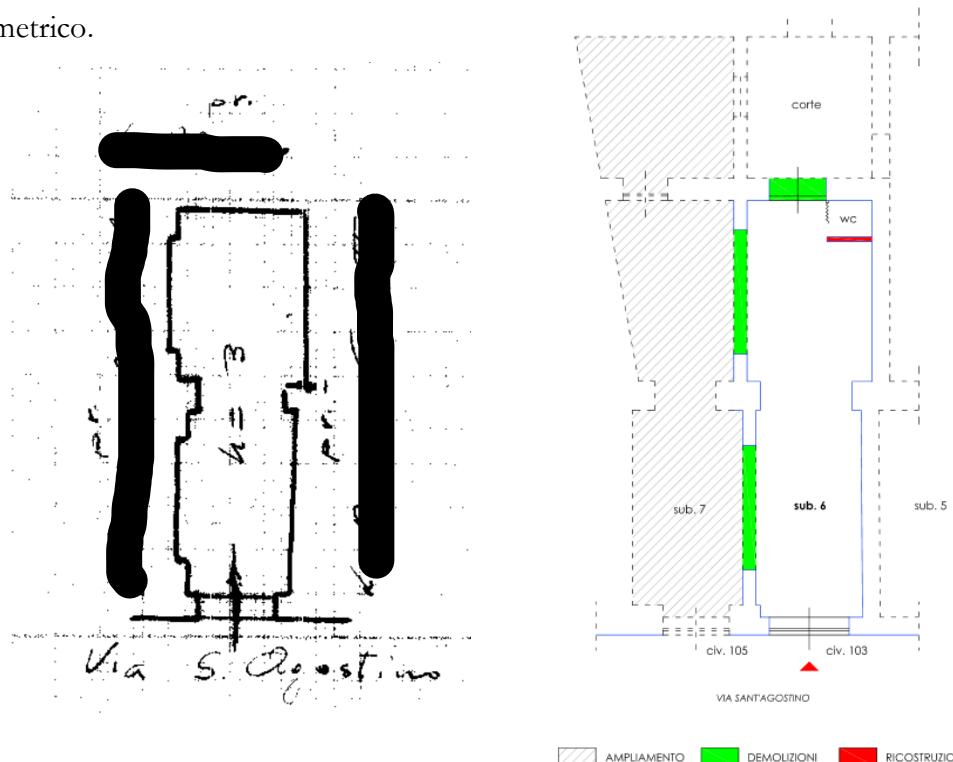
Estratto planimetria catastale del 06.12.1939.
